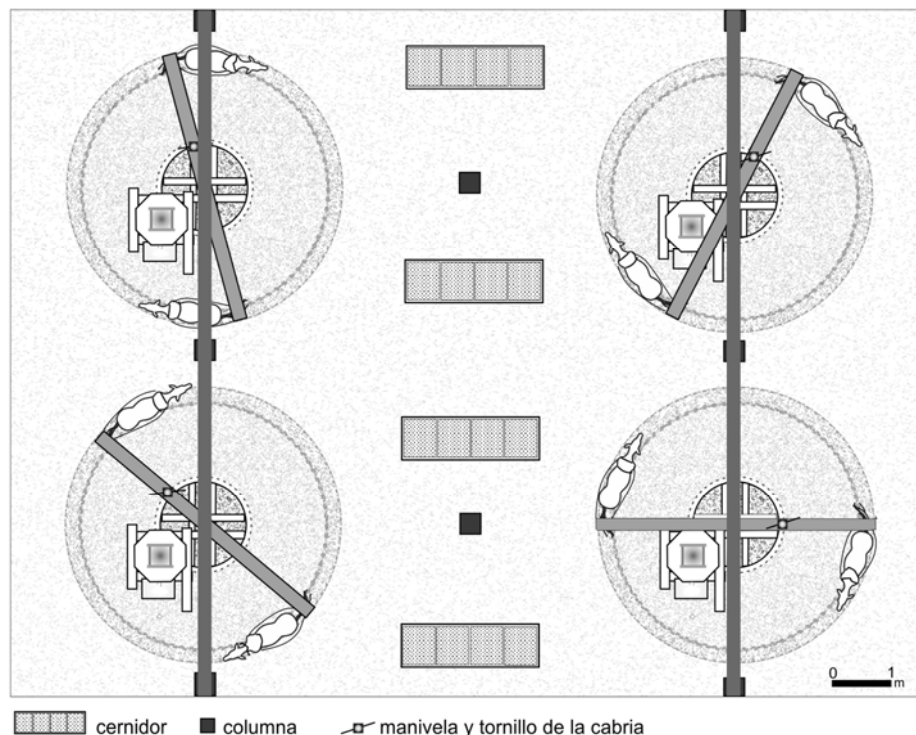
Vista en planta de una hipotética reconstrucción de cuatro asientos de atahona con ocho mulas.
